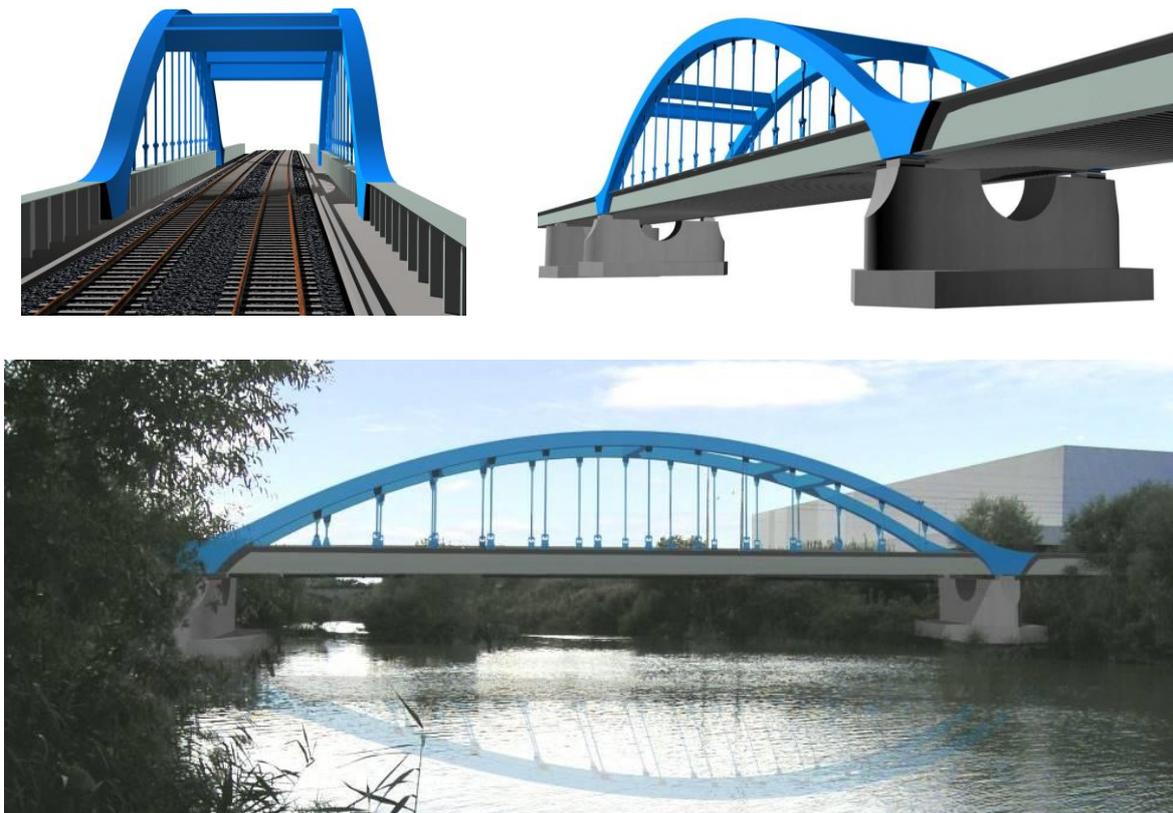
Viste prospettiche e inserimento ambientale (rendering)
